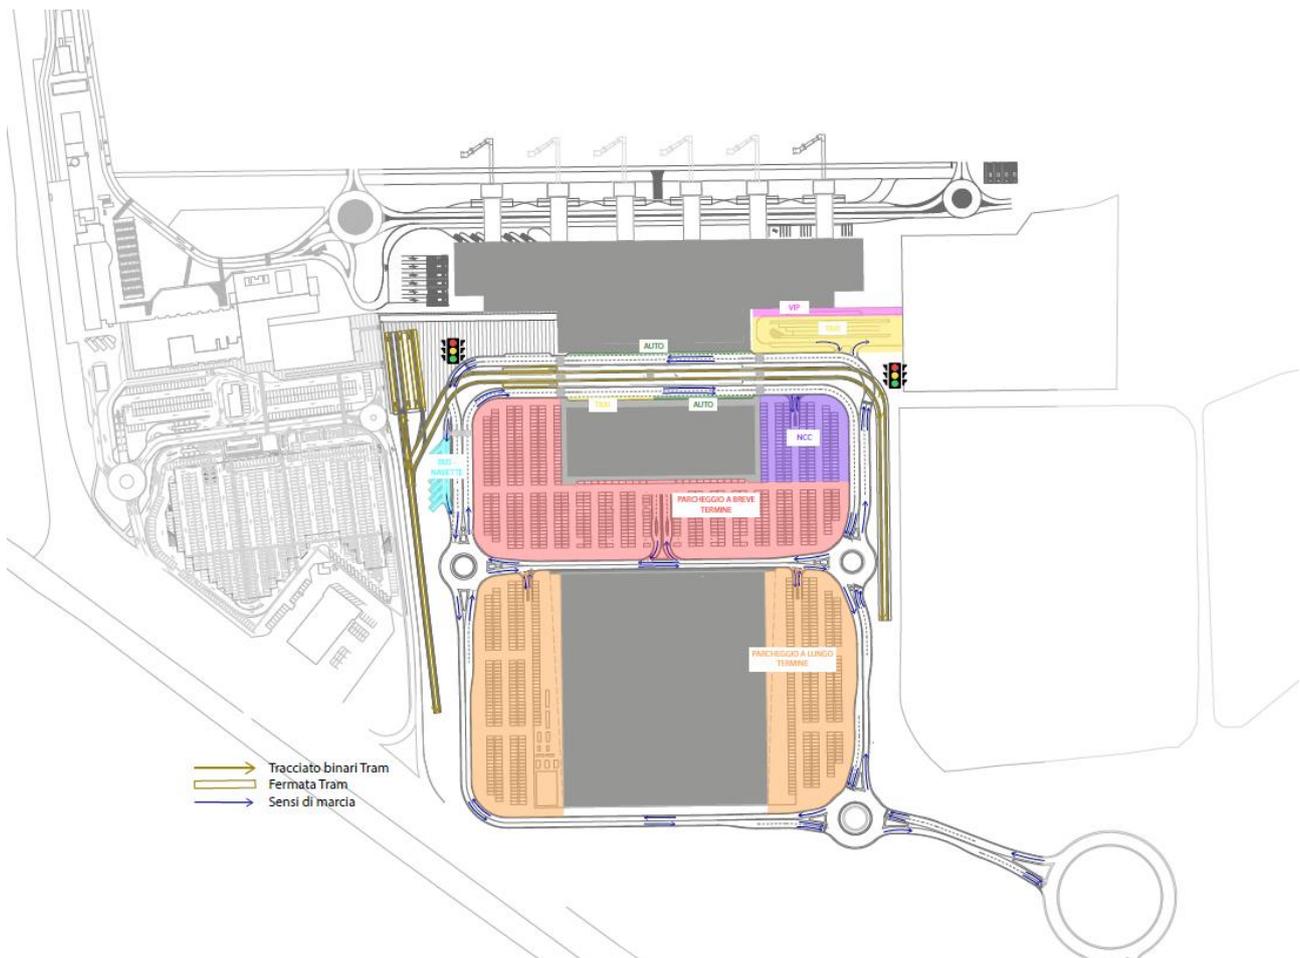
| Schema planimetrico viabilità e sosta di progetto
